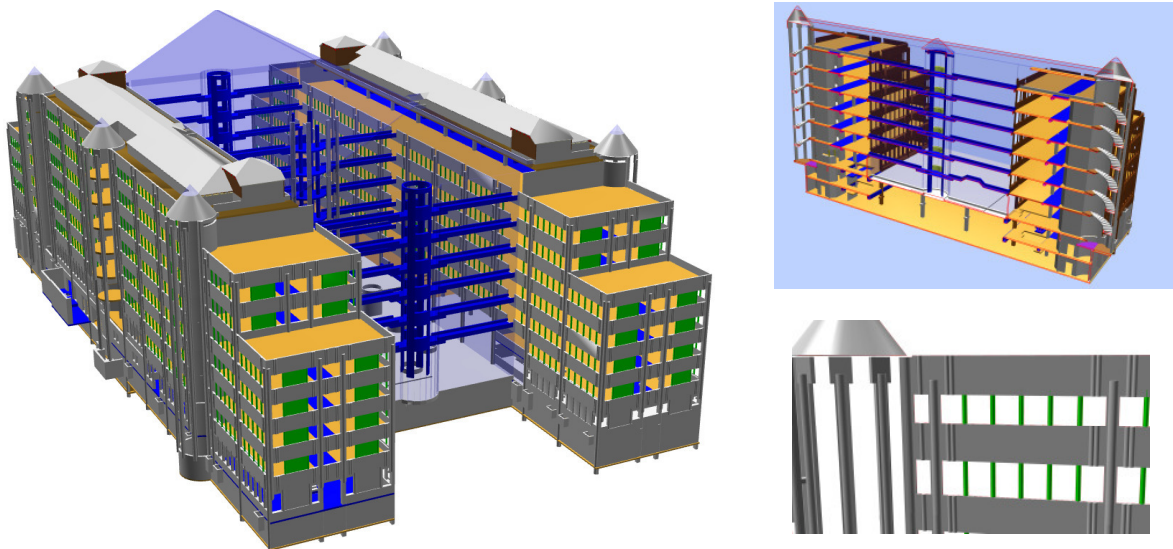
Das Bestandsgebäude Züblin-Haus modelliert mit Nemetschek Allplan
